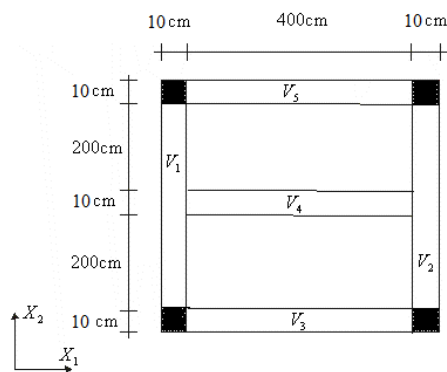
Placa enrijecida com quatro vigas externas e uma viga interna
